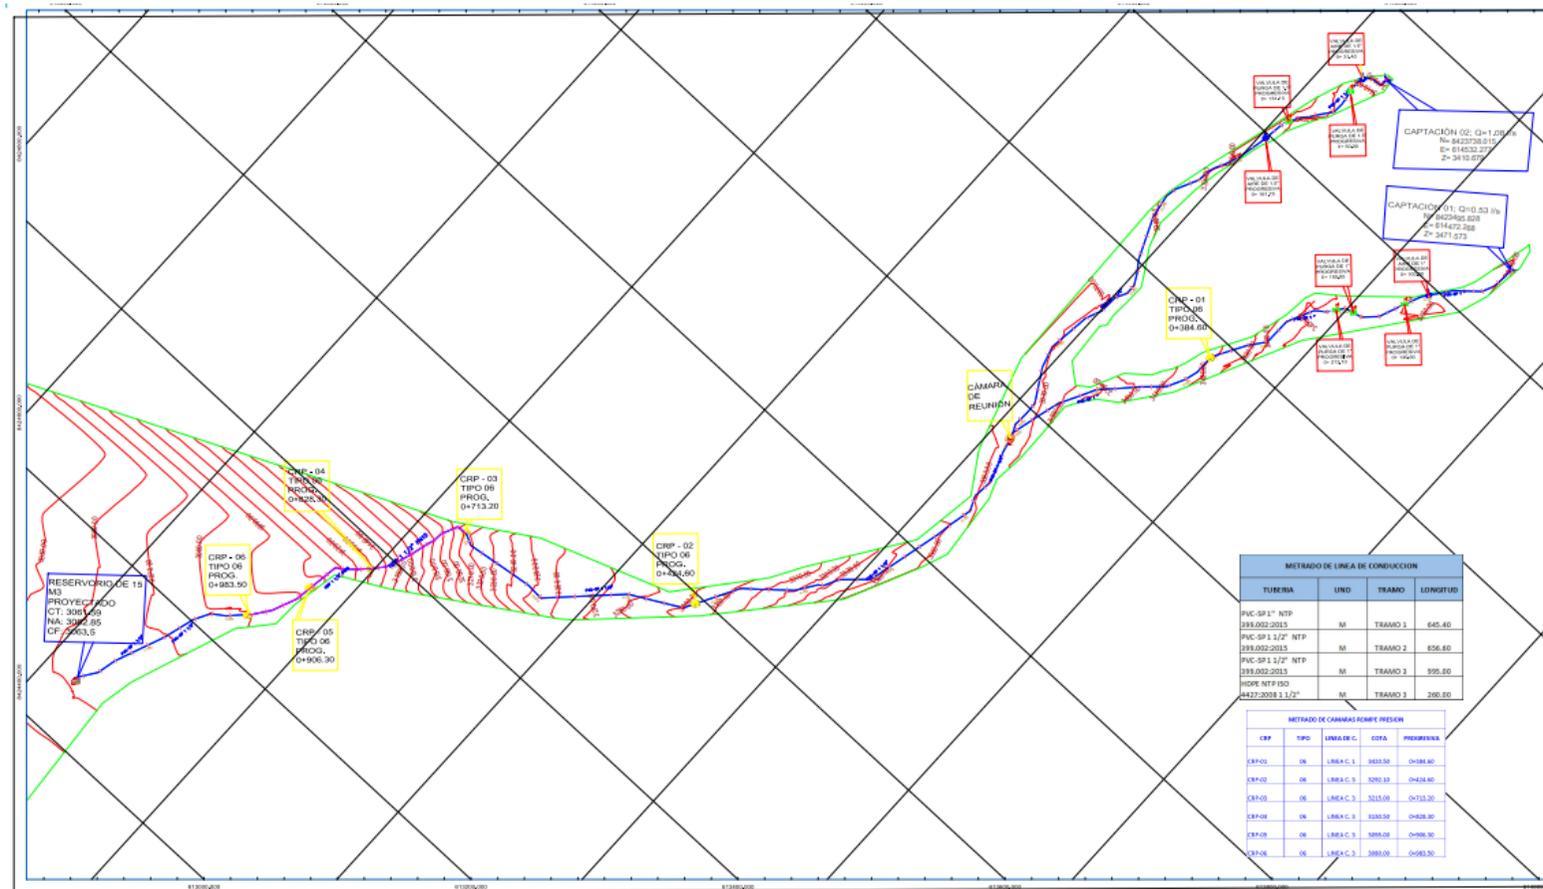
Plano clave de la línea de conducción del sistema de agua potable.
